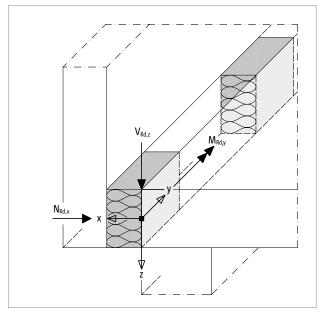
Schöck Isokorb® XT tipo AP: regola dei segni per il calcolo dei parapetti anteposti
